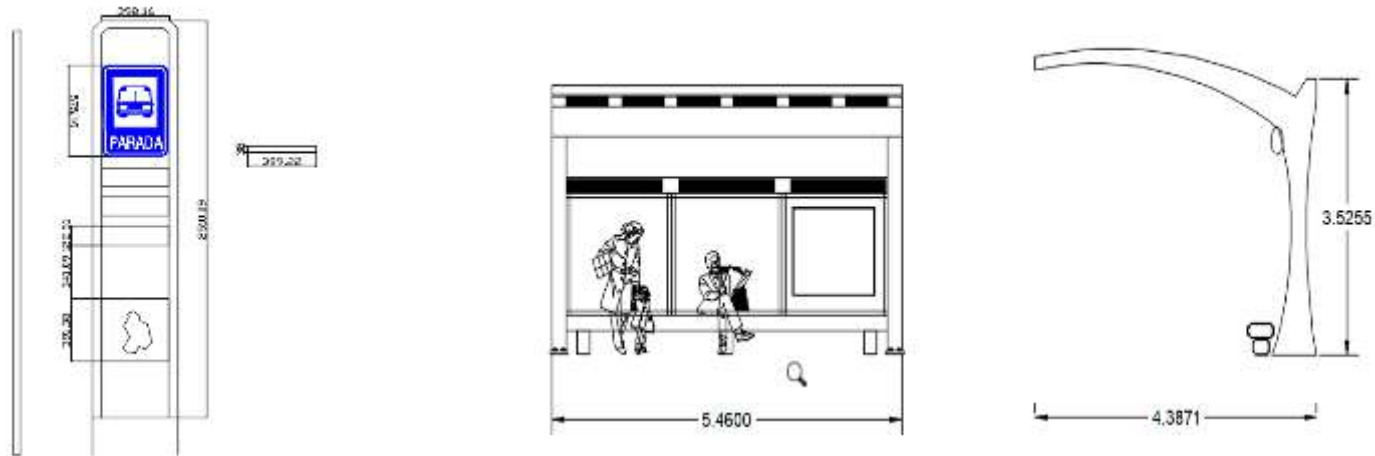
Vista de la parada en forma de tótem y cubierta
